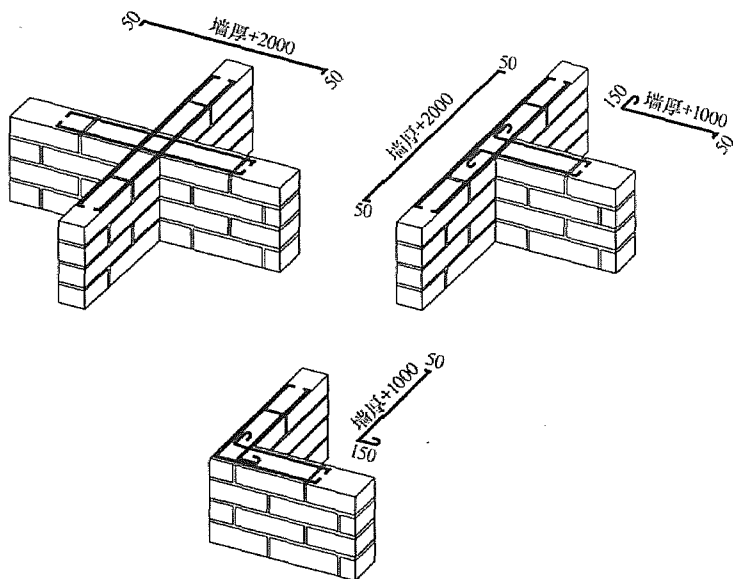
纵横墙交接处拉结钢筋做法
